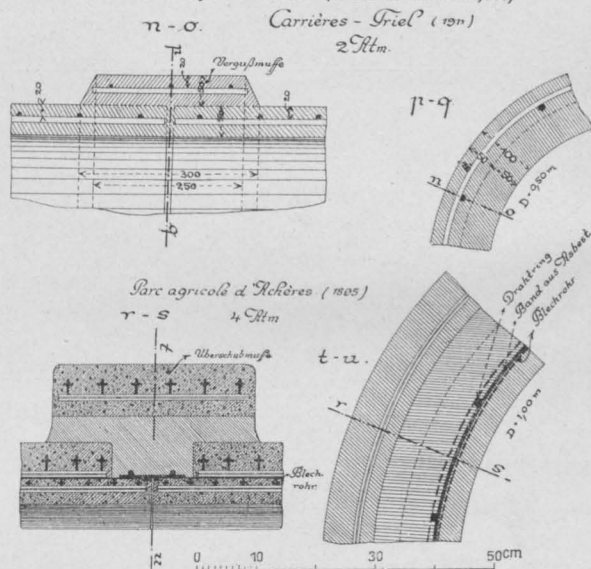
Stöße von Eisenbeton-Druckrohren.
